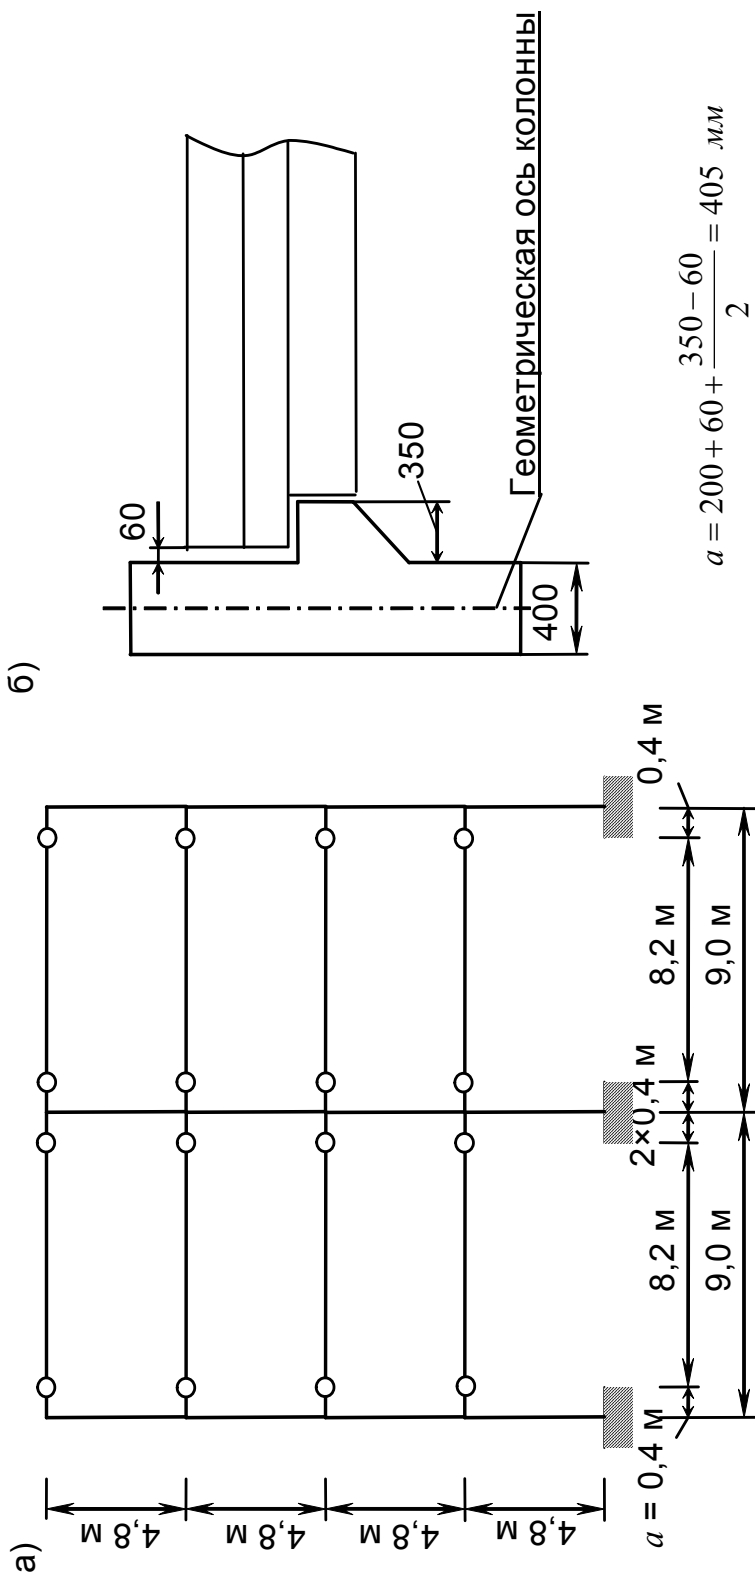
К расчёту рамы с учётом нарушения технологической последовательности монтажа перекрытий:
